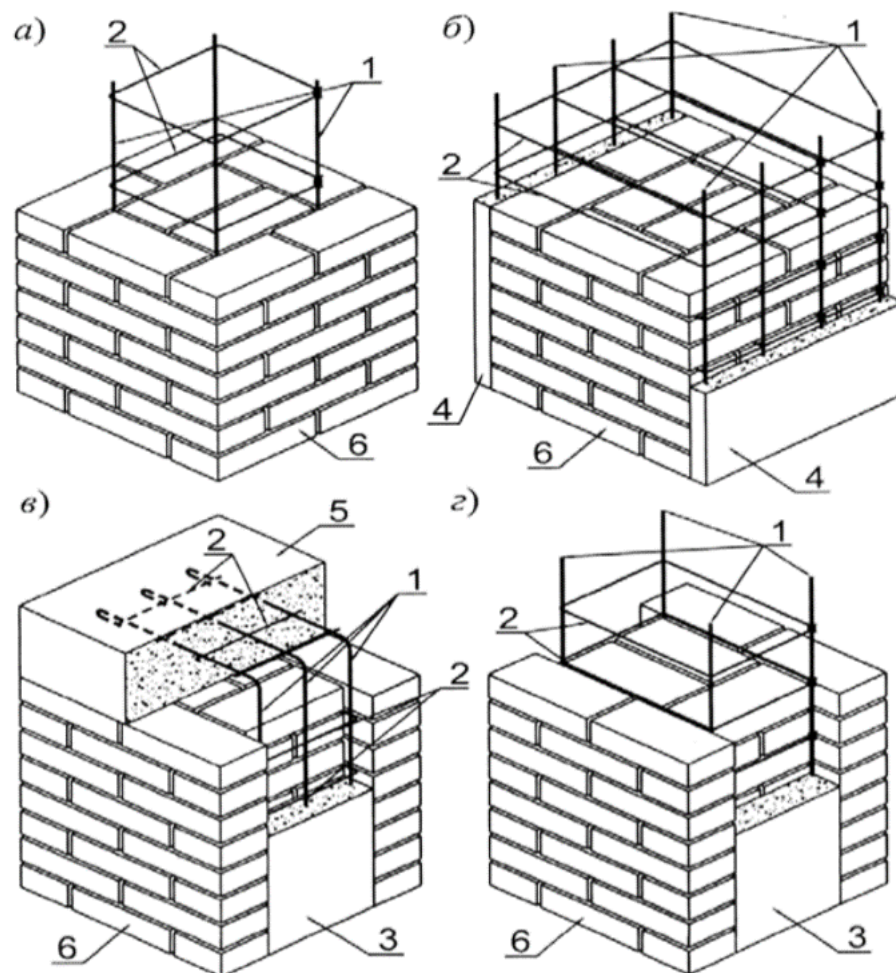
Поздовжнє армування кам'яних конструкцій:
